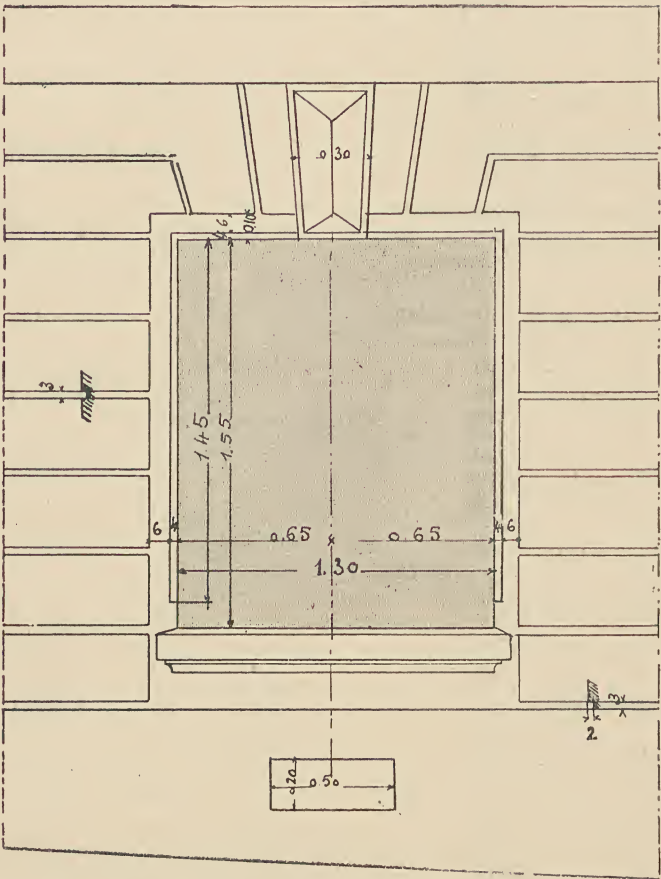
Détail d'une baie de 1<sup>m</sup>,30 à rez-de-chaussée.
